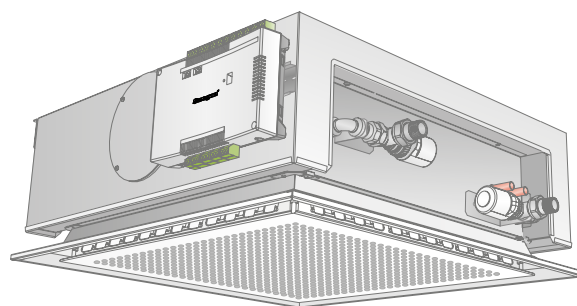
Installazione tipica, raffreddamento e riscaldamento ad acqua
